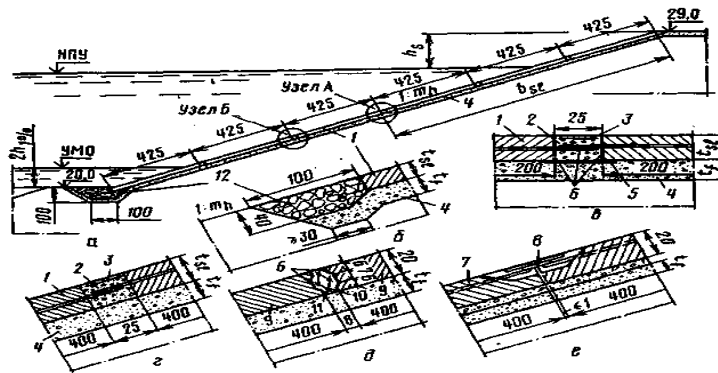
Конструкция крепления откоса сборными железобетонными плитами:
